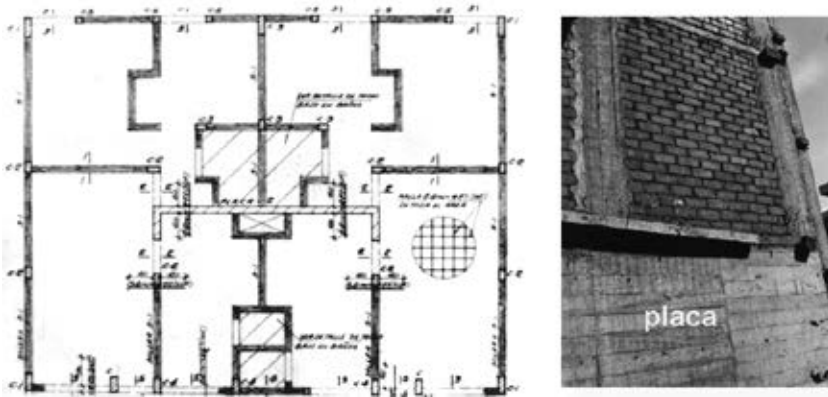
Planta de un edificio de albañilería confinada y placa adicional.
